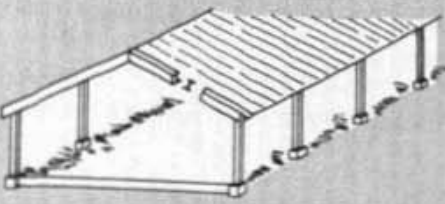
Bauweisen für Rinderställe, Beispiele für Holzkonstruktionen, Wände aus Holz oder Mauerwerk (nach RITTEL).
